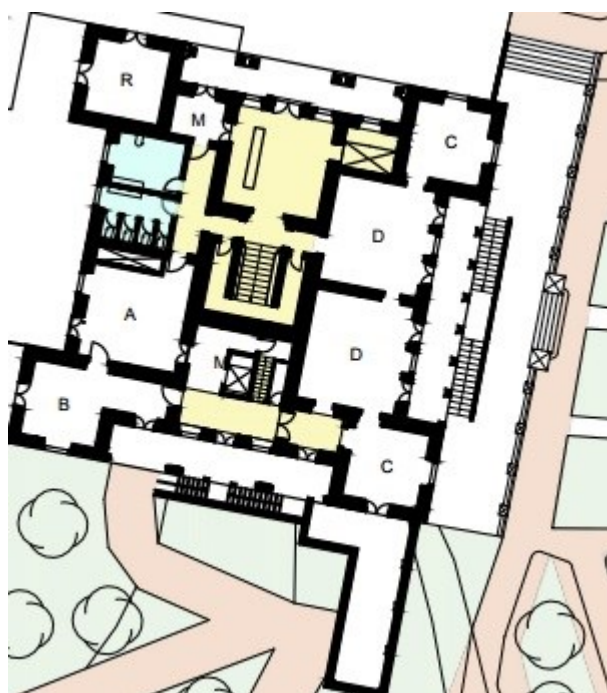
Planta do Palácio, Piso Térreo, autoria própria
